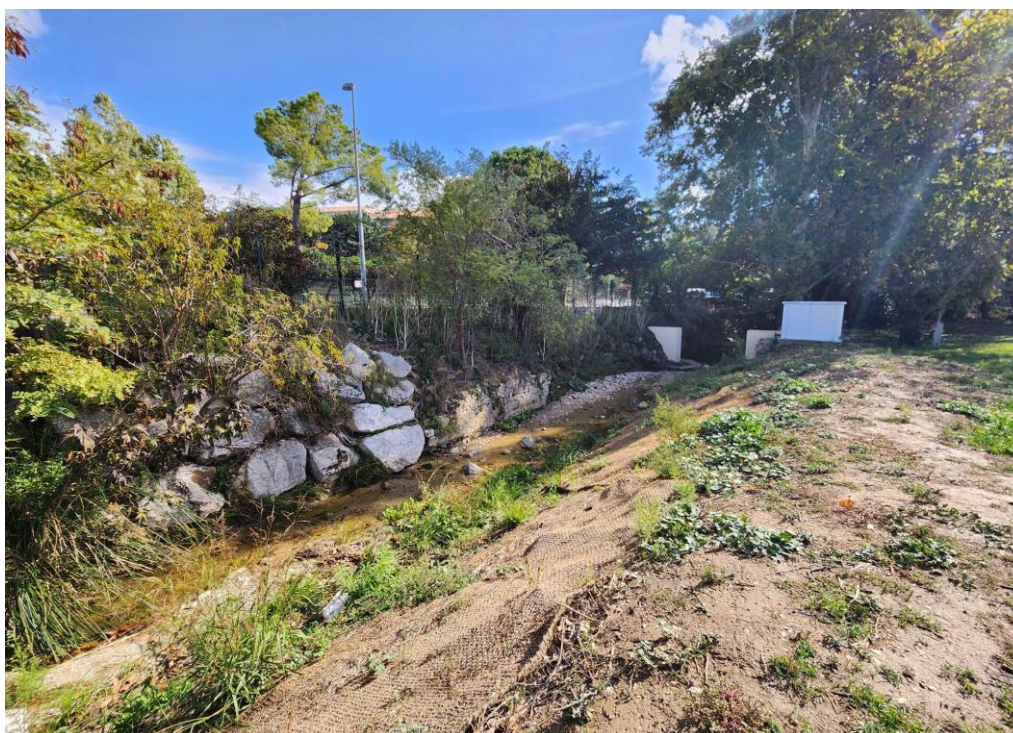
Photo prise le 24/10/2023 au Parc du Bocage, Plan - de - Cuques
